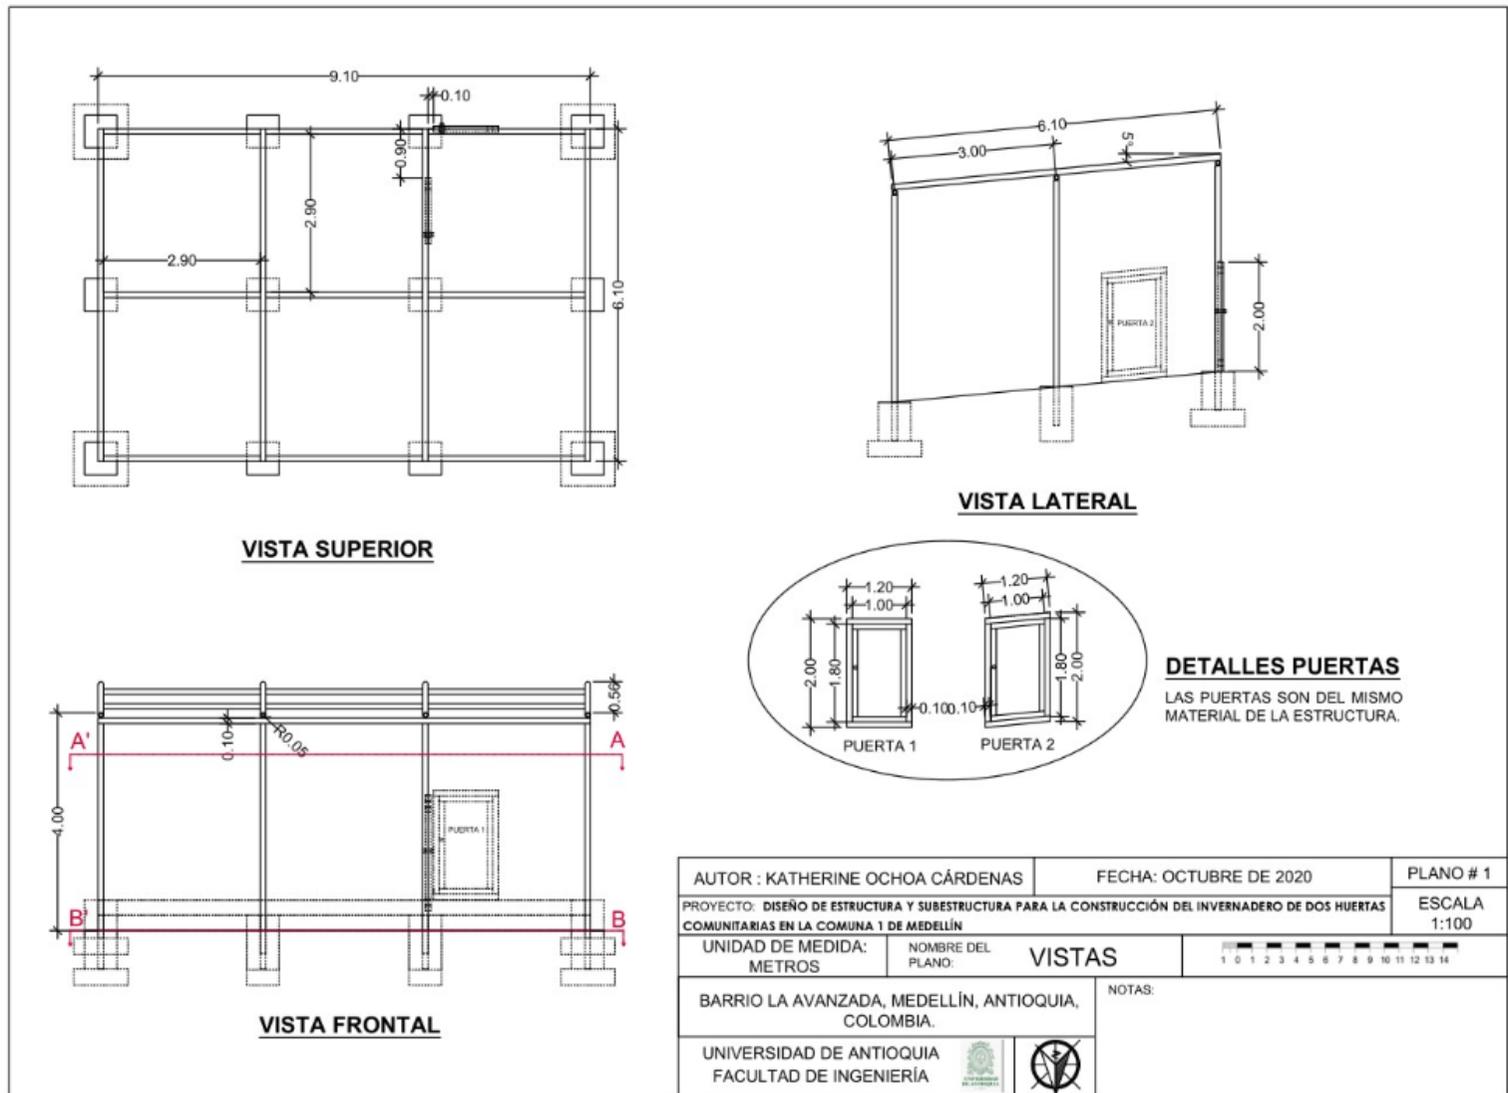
Plano #1 Vistas, Barrio La Avanzada.
